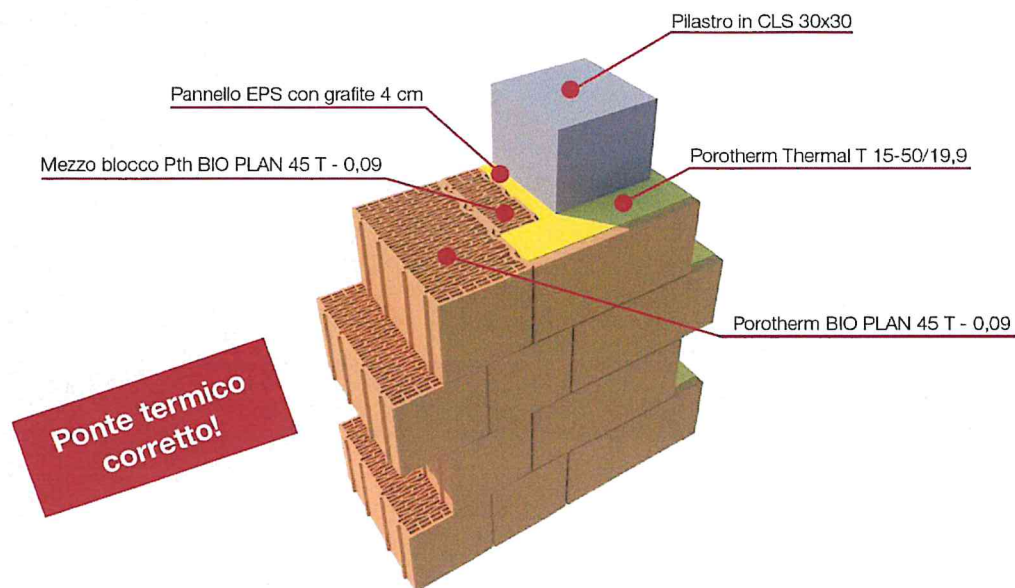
Dettaglio 3D della risoluzione del ponte termico in corrispondenza del pilastro.
